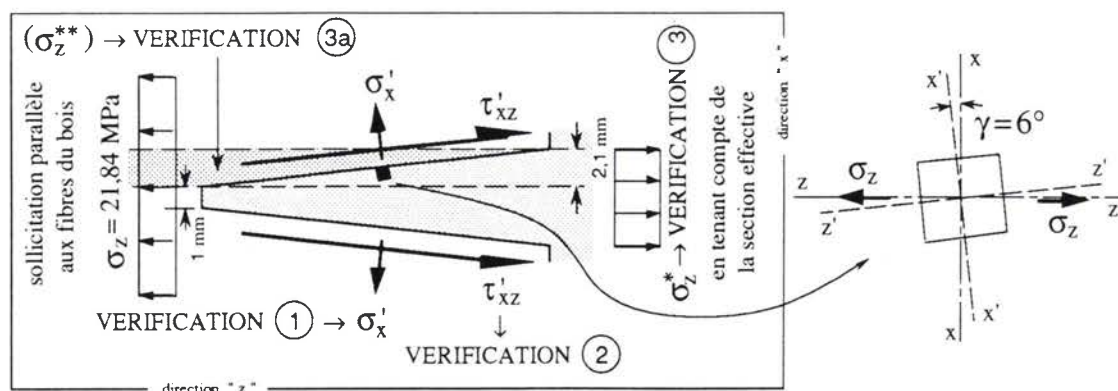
Section suivant un plan parallèle aux fibres du bois de la pièce de coin en contenant la section longitudinale des entures.
